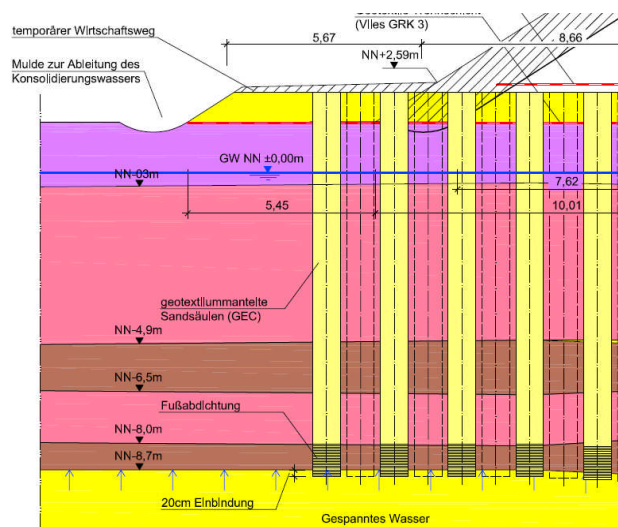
GEC mit Fußdichtung - Auszug Ausführungsplan Straßenbaumaßnahme
